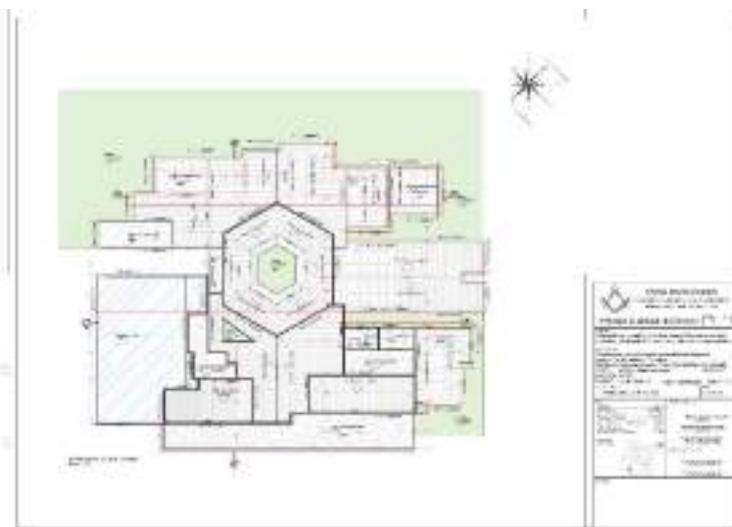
Prancha de Planta layout do pavimento superior, detalhe e render
